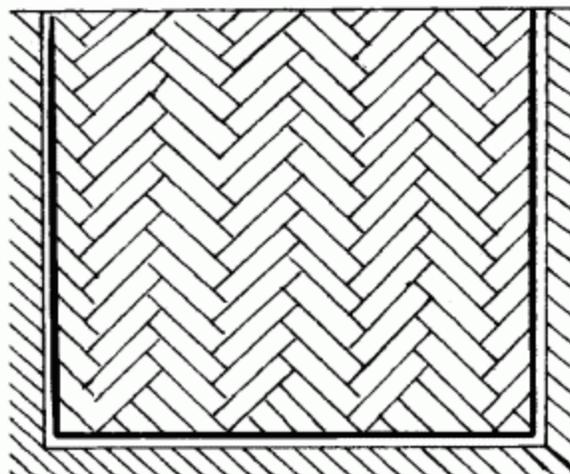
Заполнение треугольными планками пустот у торцовых стен.
